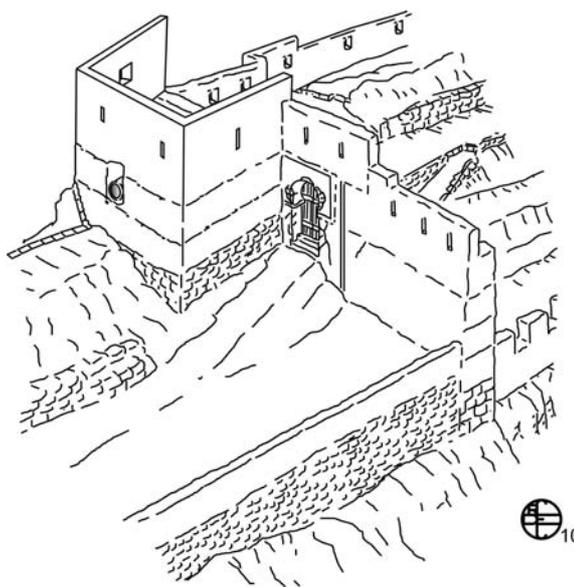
Vista de la batería y la muralla sur desde el exterior
